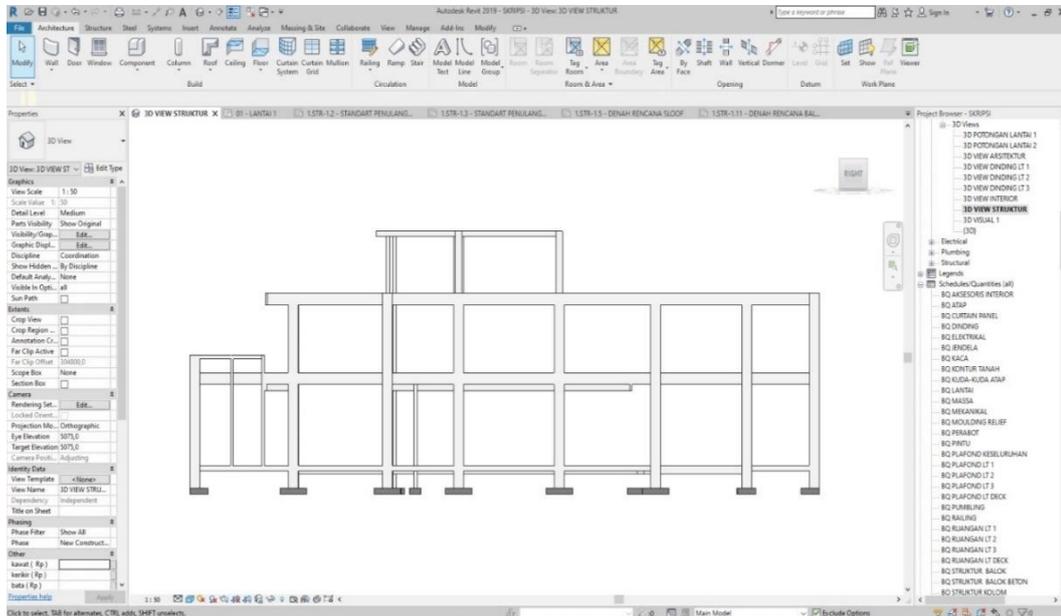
Tampilan Memasukkan Struktur Pondasi Telapak Ke Dalam Permodelan
